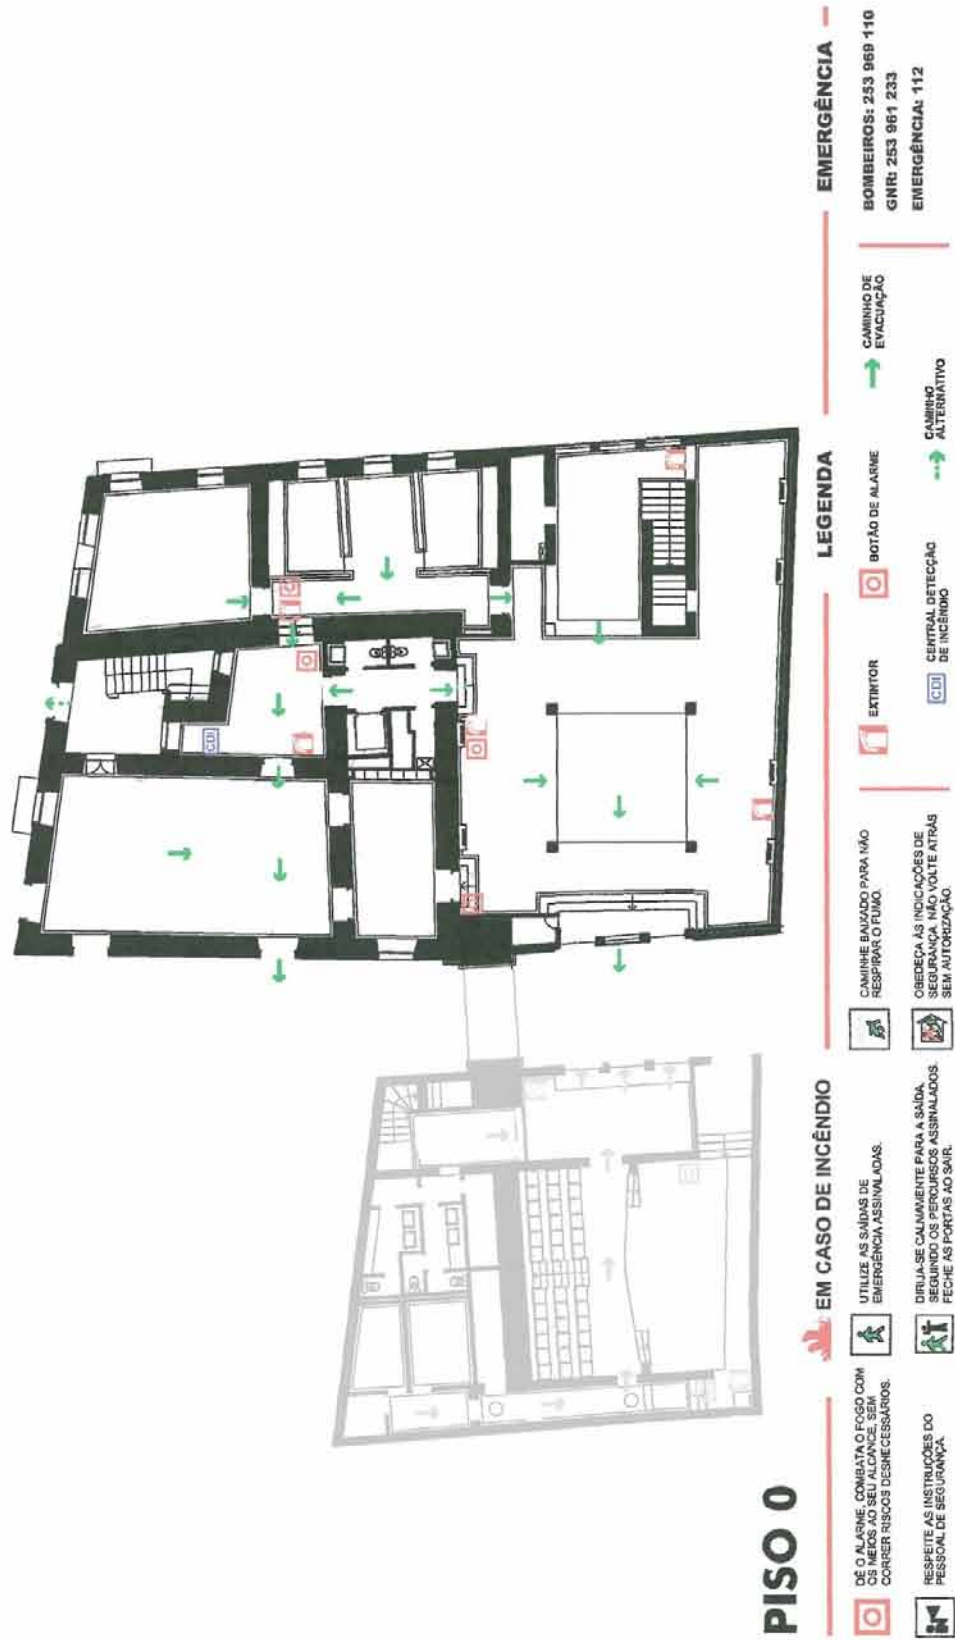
Planta de Emergência do piso 0 (Proposta)
